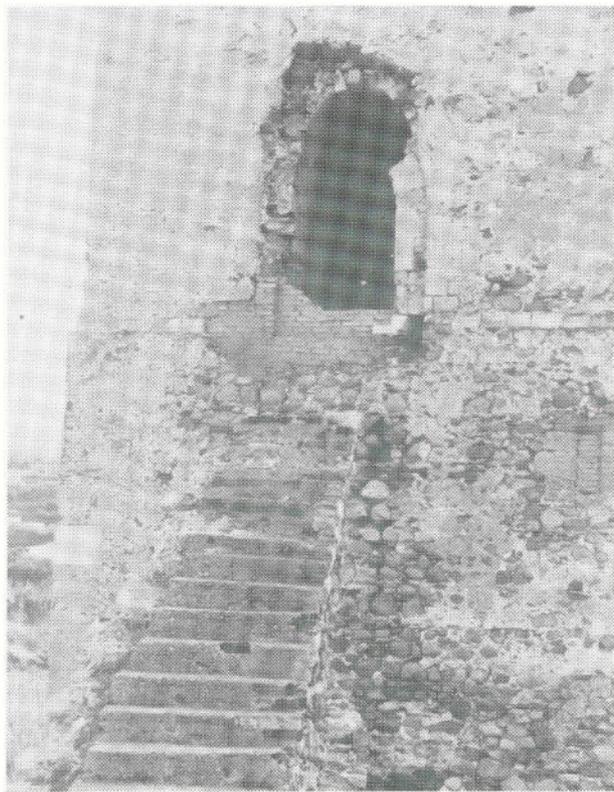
Prospetto N: la rampa scalare e la porta d'ingresso.
